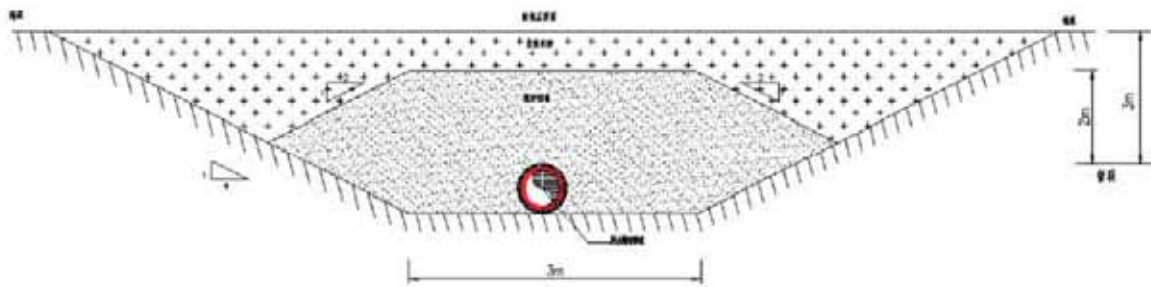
(c) 航道段预挖沟及埋设保护断面图
